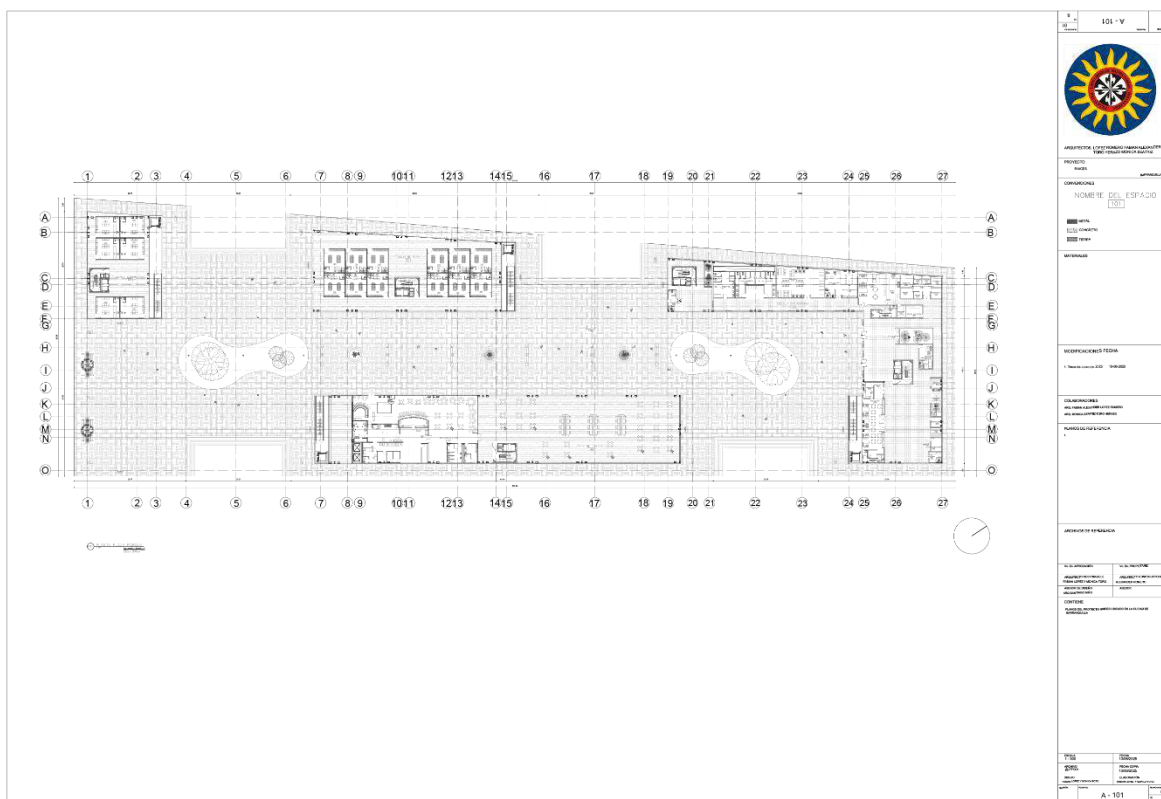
Planimetría primer piso. Fuente: Elaboración propia.
